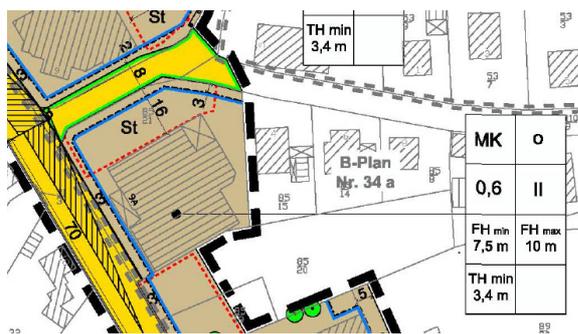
Bebauungsplan Nr. 42 (Auszug)
